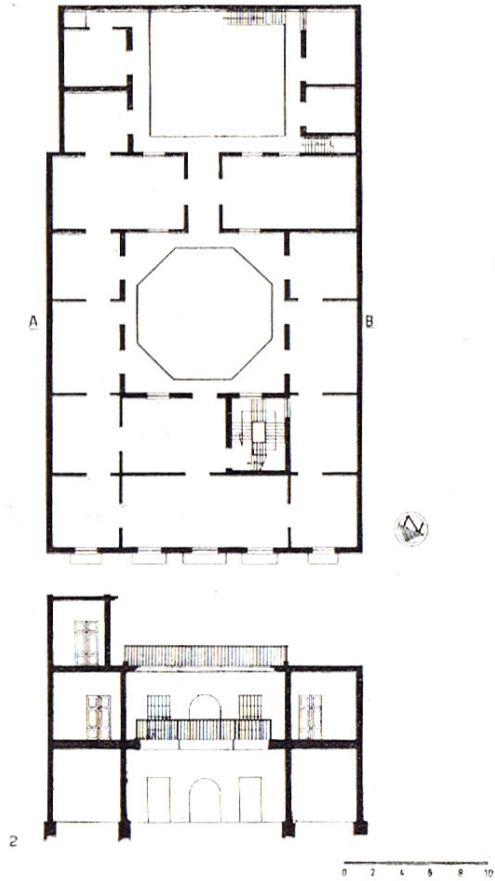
Casa de Montero o Roosen — Planta alta y corte.
